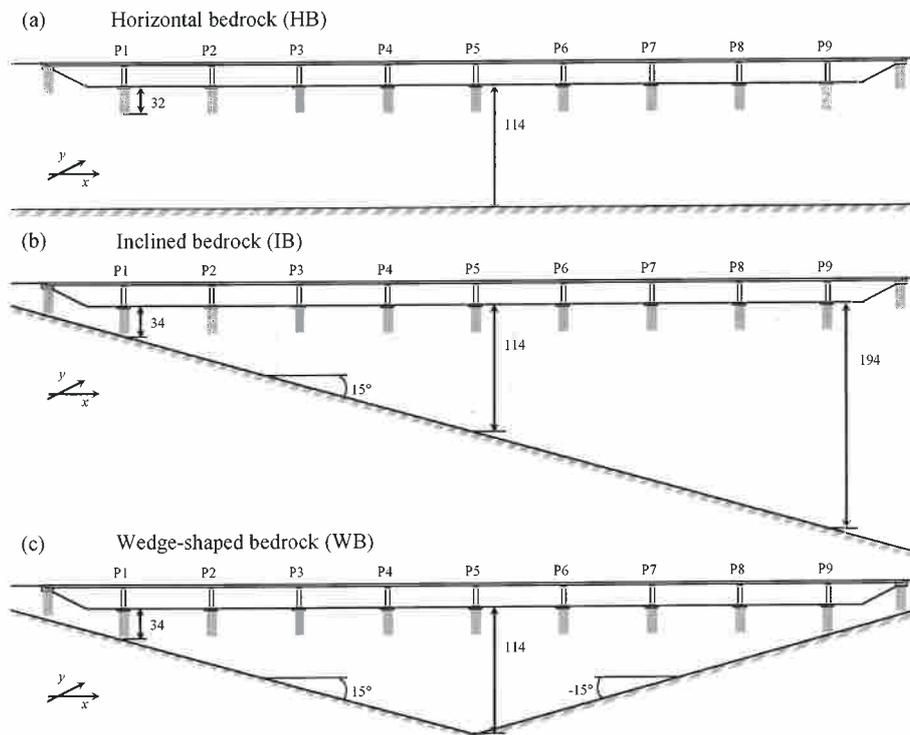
Vista laterale del viadotto sui substrati di terreno deformabile: a) Horizontal bedrock (HB); b) Inclined bedrock (IB); c) Wedge-shaped bedrock (WB).
